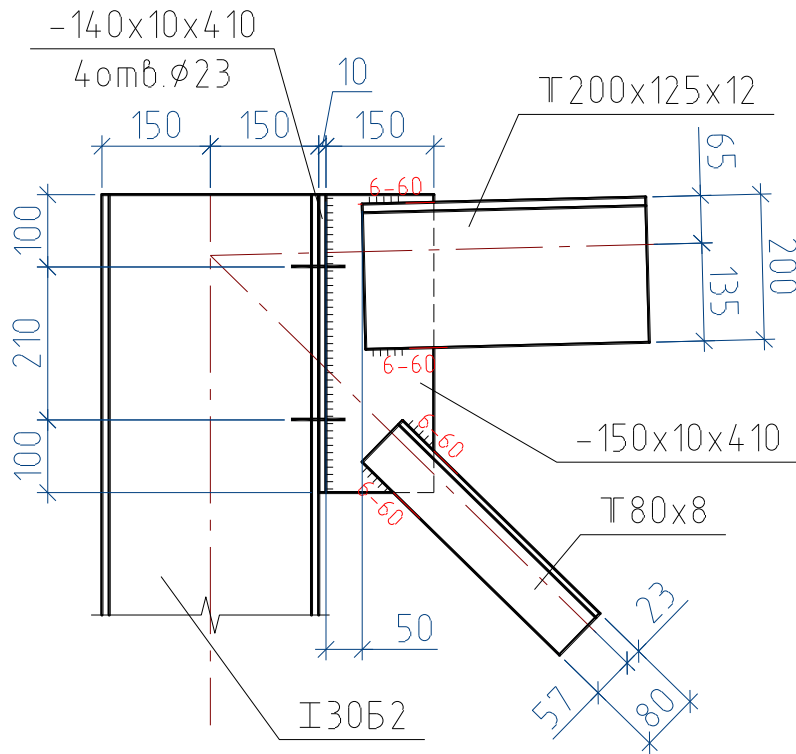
Узел примыкания верхнего пояса с надколонником
